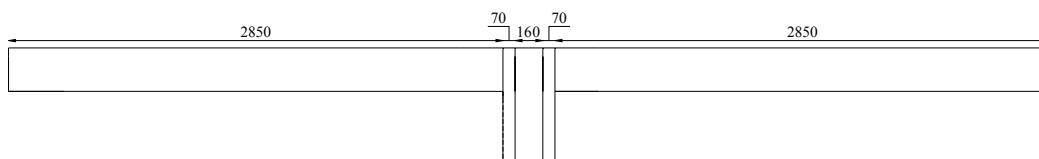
Discretização horizontal da seção transversal do modelo *viga em concreto protendido composta*.
